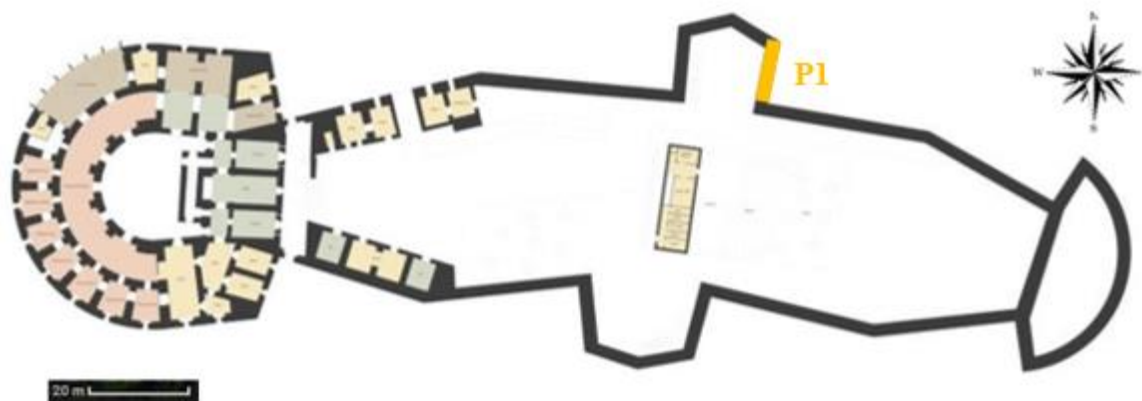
Planta da Citadella com a parede alvo de testes evidenciada a laranja.
